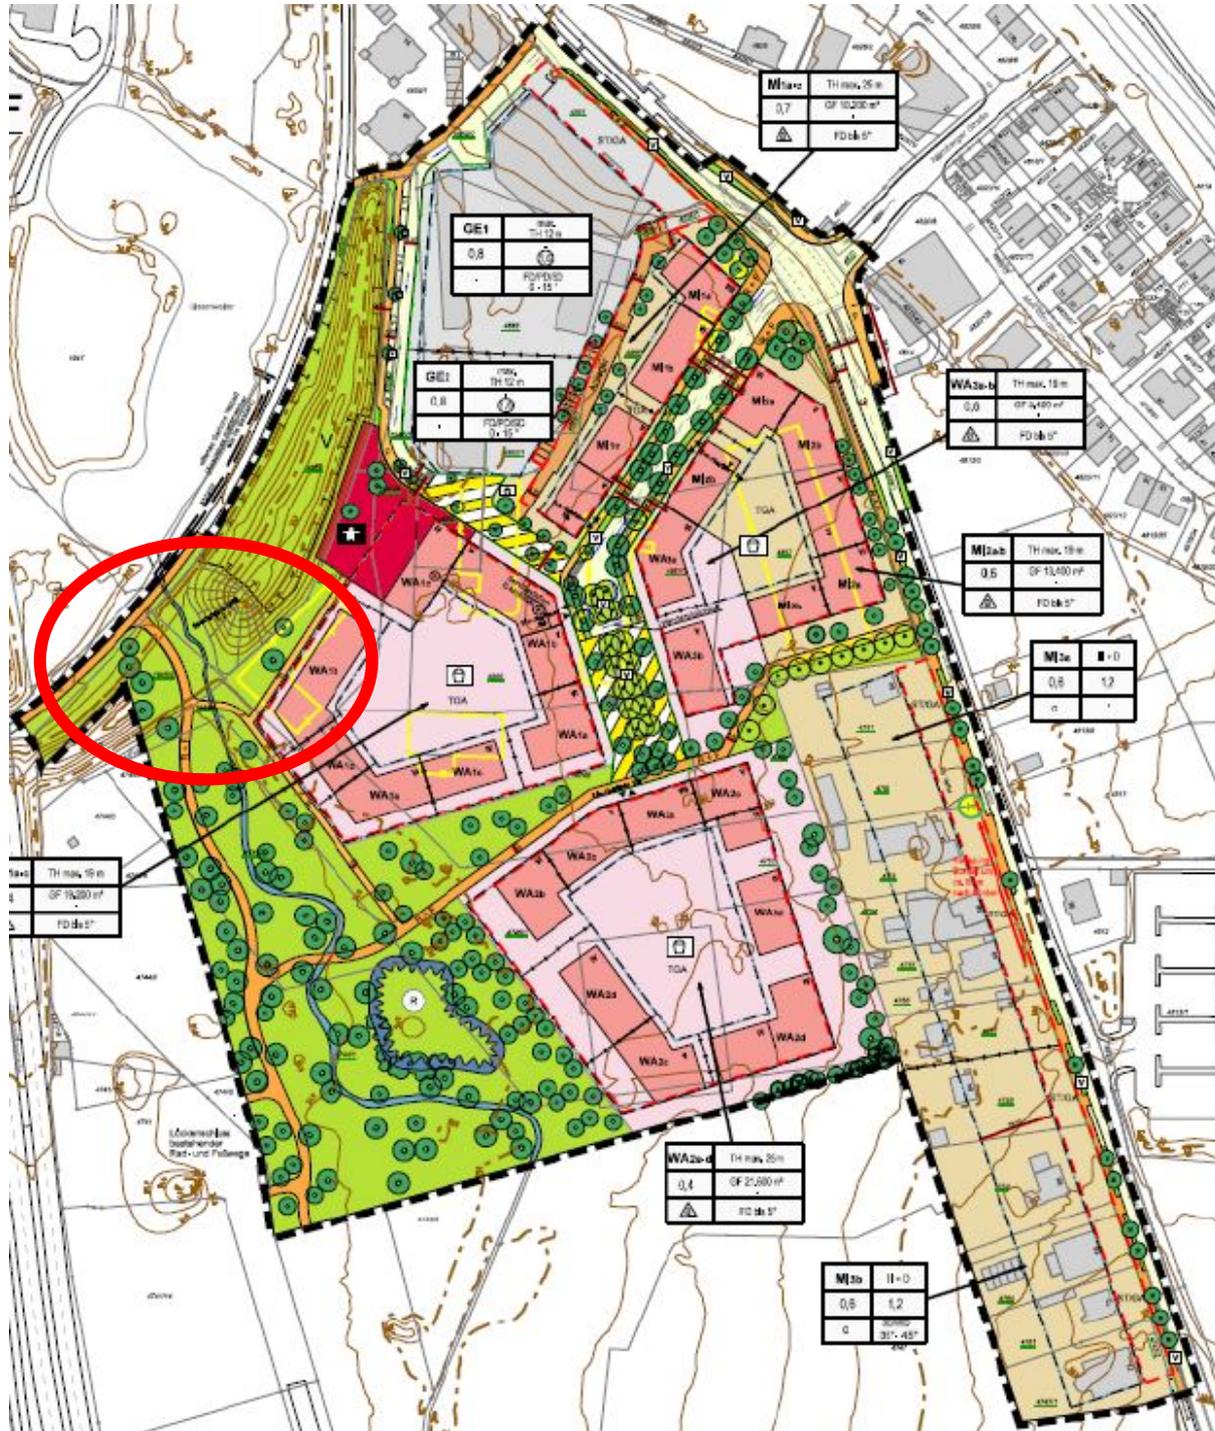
Darstellung aus dem Bebauungsplanverfahren 4/18 inkl. Öffnung des Lärmschutzwalls (STADTPLANUNGSAMT BAYREUTH 2022)
